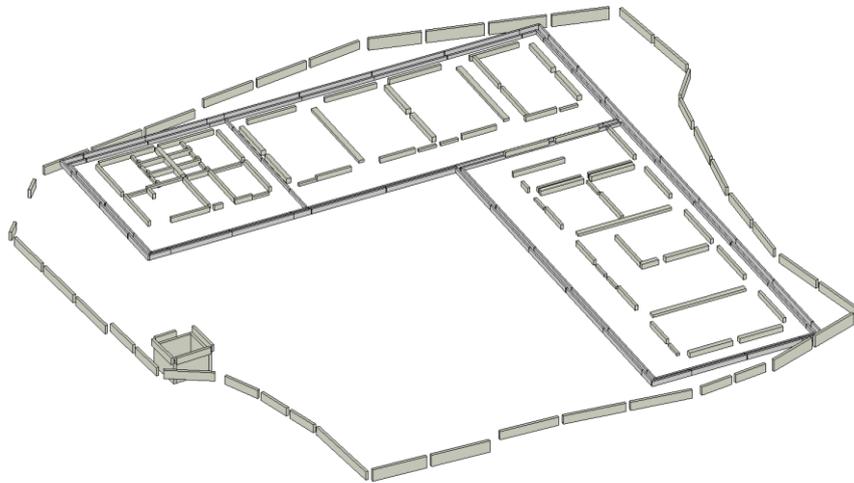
Categoría Muros aislada del modelo federado de Estructuras
